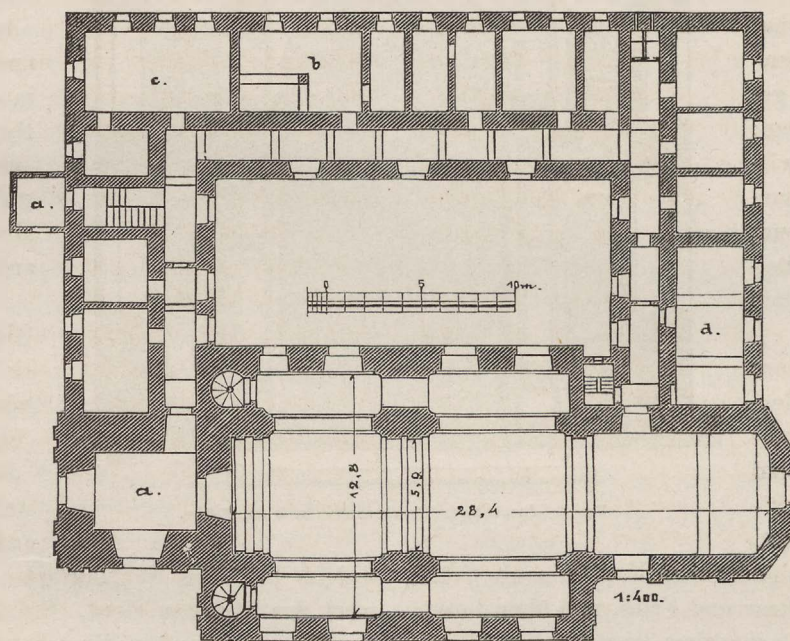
Jacobsdorf. Grundriss des Klosters und der Kirche.
